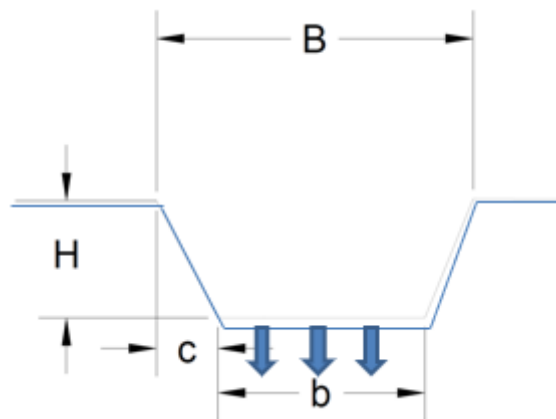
Schema di fosso trapezio senza inv. Idraulica (filtrazione solo sul fondo)
